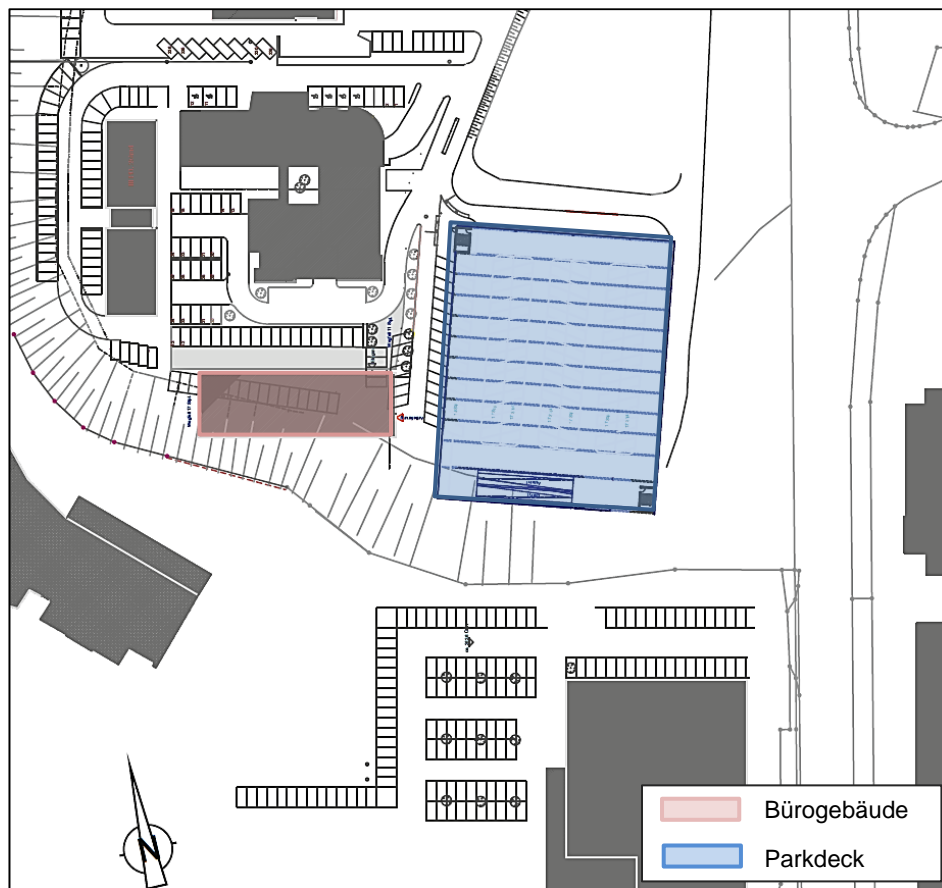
Grundrissplan des Bauvorhabens mit Parkdeck für 300 Stellplätze
